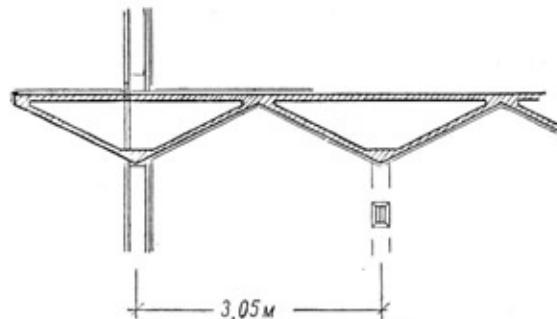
Шедовое покрытие промышленного здания можно рассматривать как складчатую конструкцию, если в ней нет вертикальных несущих элементов
